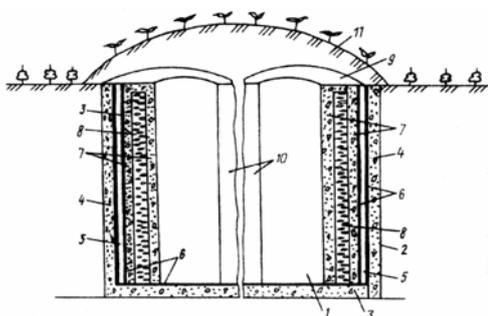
Способ рекультивации известняковых карьеров: 1 — карьер; 2 — стенки карьера; 3 — сформированный пол; 4 — сформированные стенки из керамзитобетона; 5 — теплоизолирующий контур; 6 — гидроизоляция; 7 — парные упорные стенки; 8 — водный лед; 9 — перекрытия; 10 — колонны; 11 — обвалка из вскрышных пород
